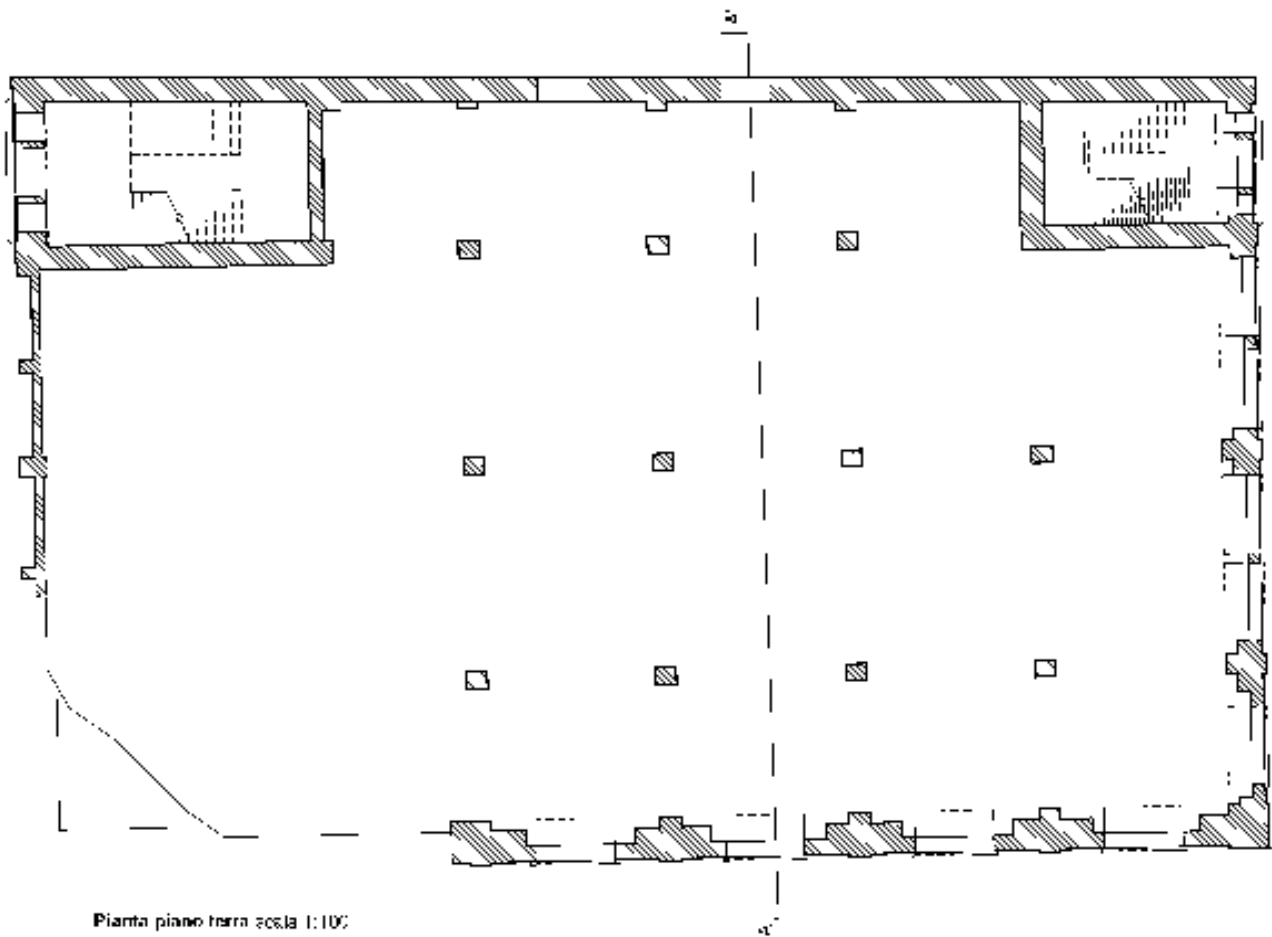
Edificio 11, Uffici e magazzini spedizioni. Stato di fatto rilevato dal gruppo di ricerca, pianta piano terra estratta dal modello informativo BIM.
